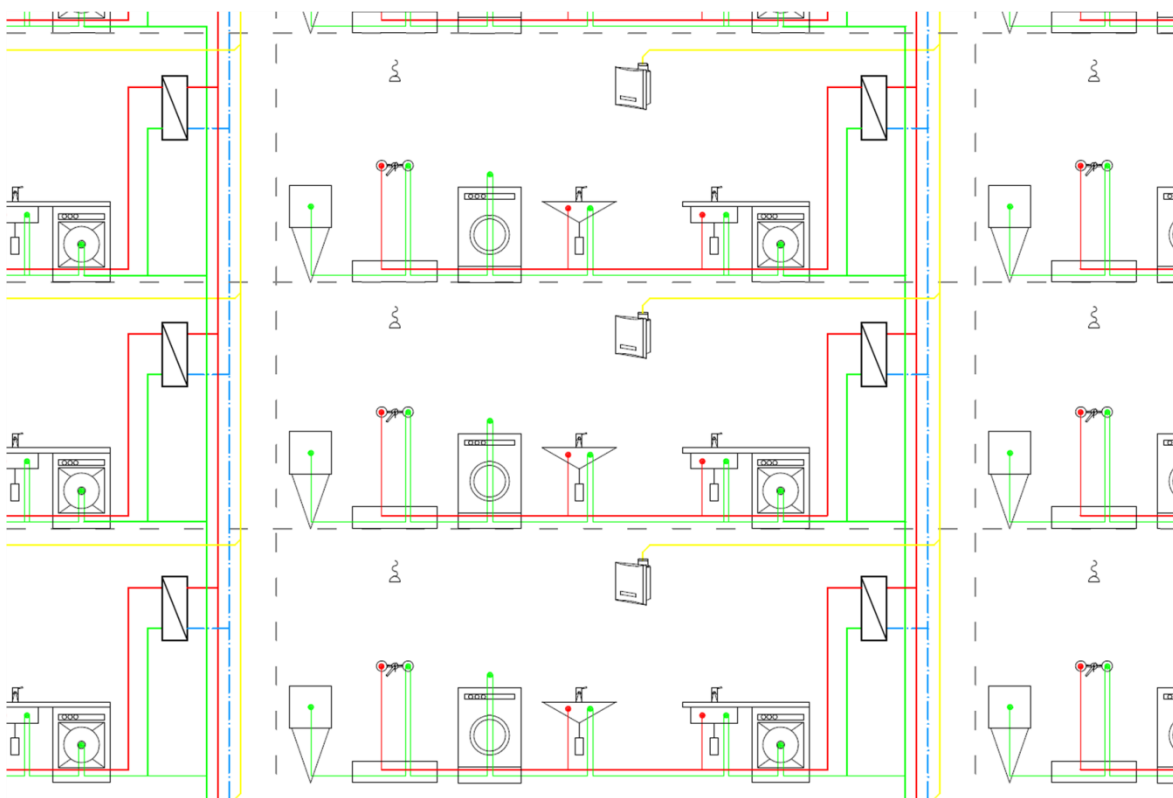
Ausschnitt eines Grundrisses zur Planung der Wasserversorgung (gesamtes Schema in Anhang D)
